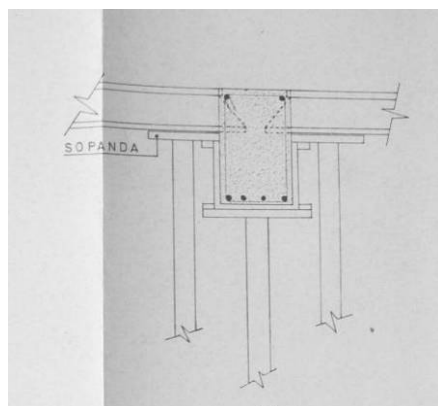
Detalle de ejecución del forjado Edificio ficha 212C.009, 1972.
